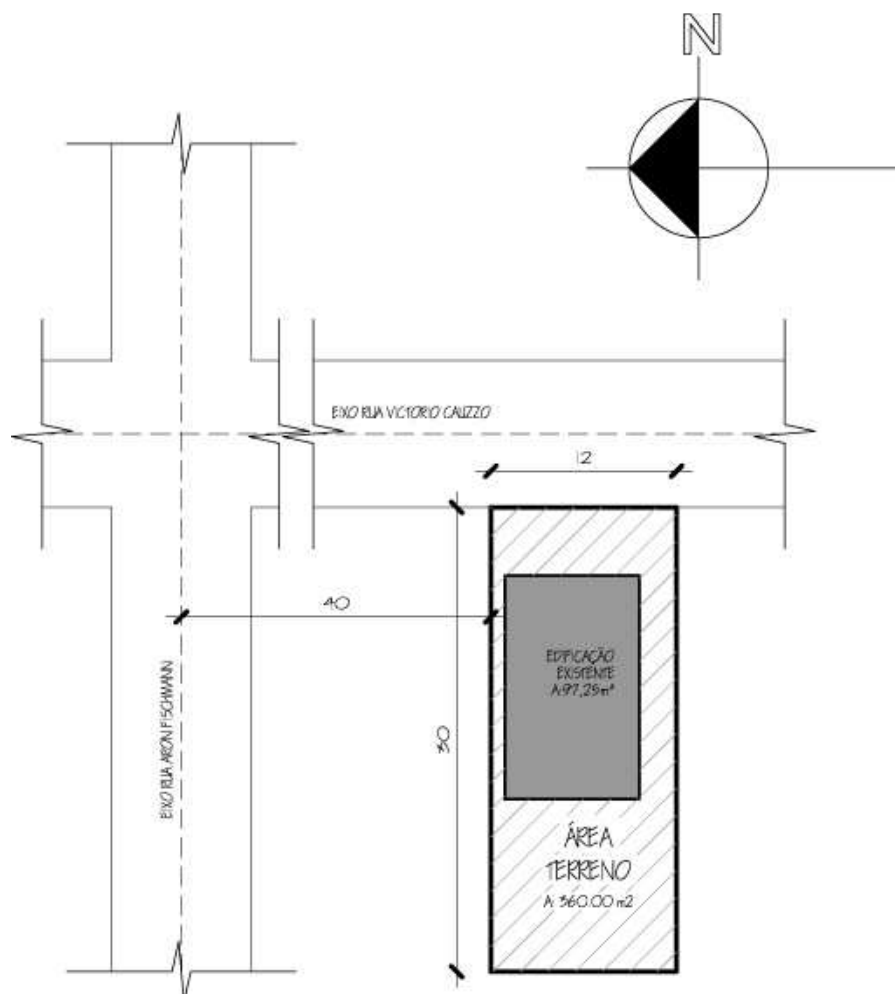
Modelo de planta para definição dos pontos de medição
